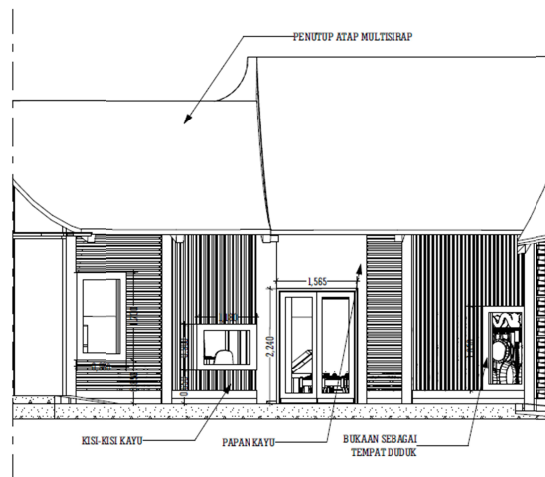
Tampak Barat Massa Bangunan Keempat
